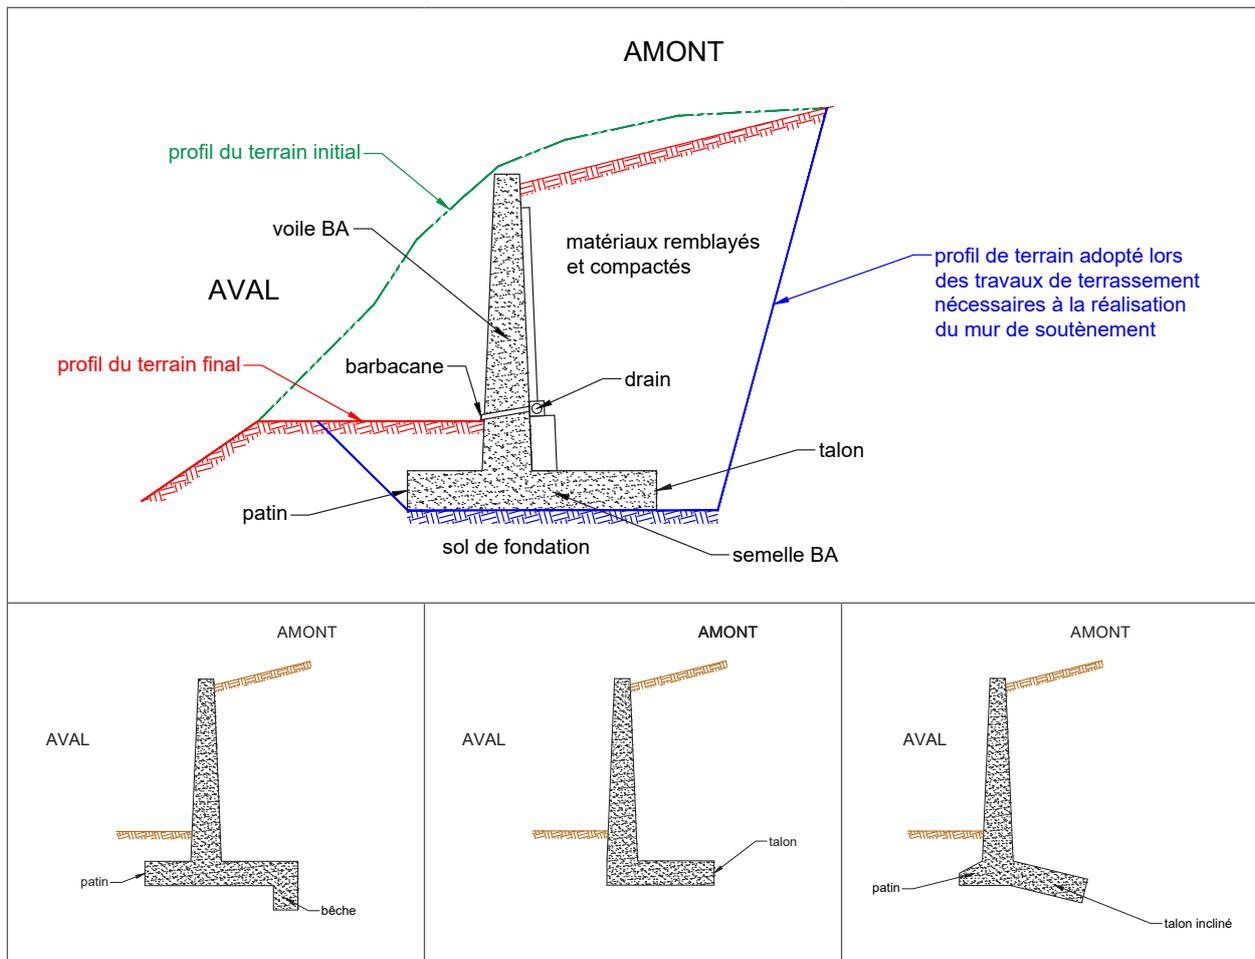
Coupe type d'un mur en béton armé (BA) encastré sur une semelle en « T » renversé ou en « L »
